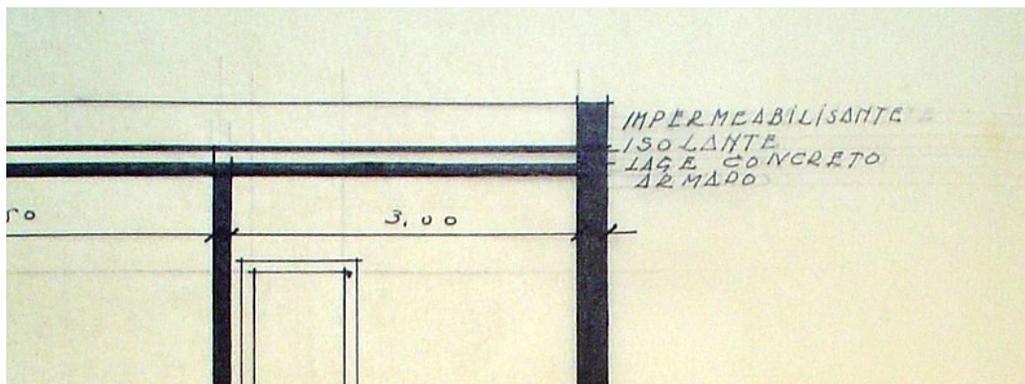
Detalhe da laje de cobertura do Grande Hotel com isolante e impermeabilizante.
